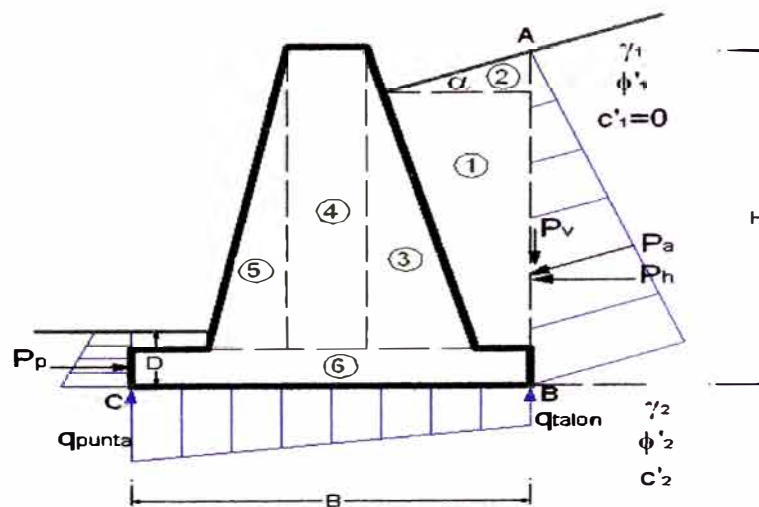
Fuerzas que actúan sobre un Muro de Gravedad
